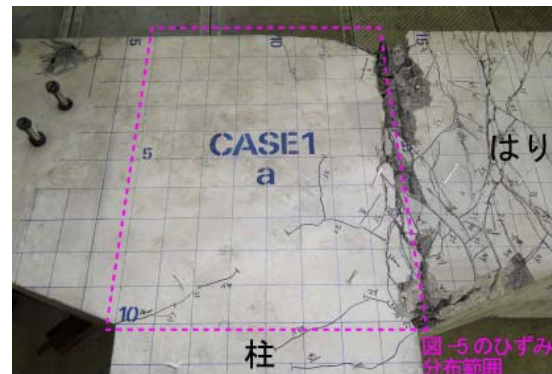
実験終了後の接合部付近のひび割れ状況
